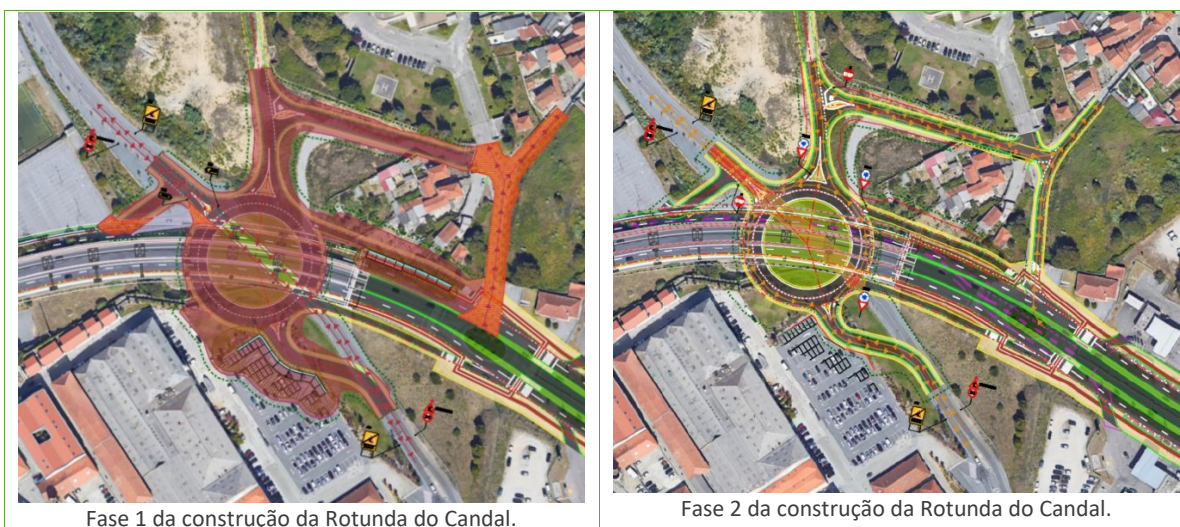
Enquadramento das fases de desvio de trânsito para construção da Rotunda do Candal
